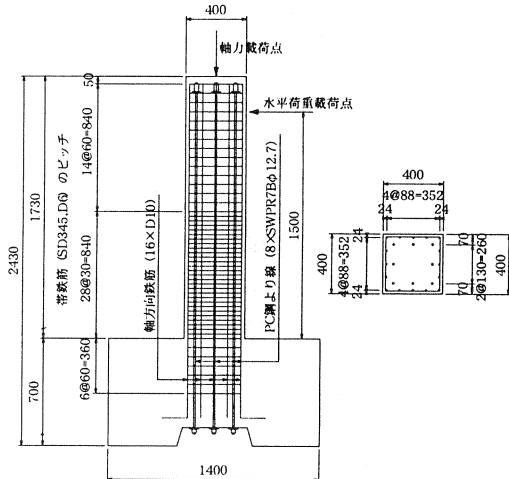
S-3(PC)供試体の配筋 及び PC鋼材配置図
